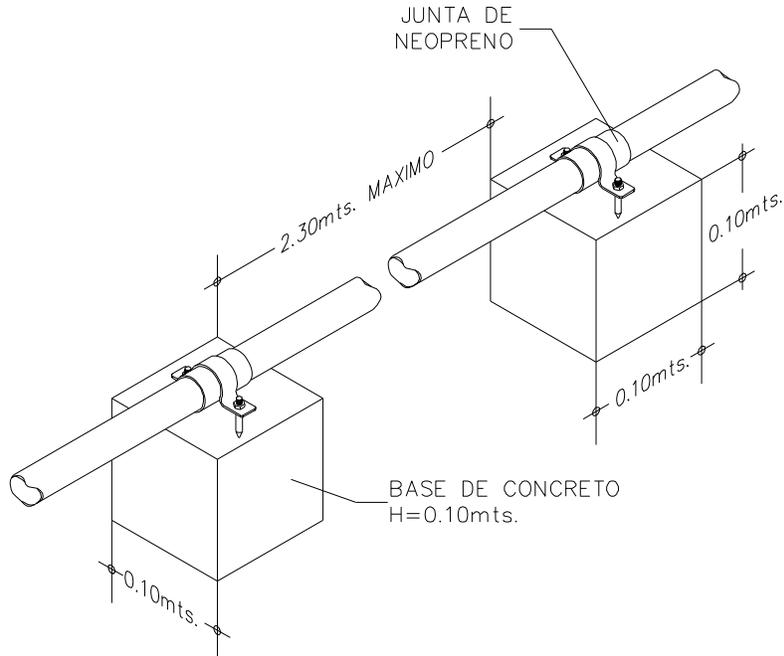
Tubería sujeta sobre base de concreto que se instalará en la azotea para distribuir el gas LP a los locales.
